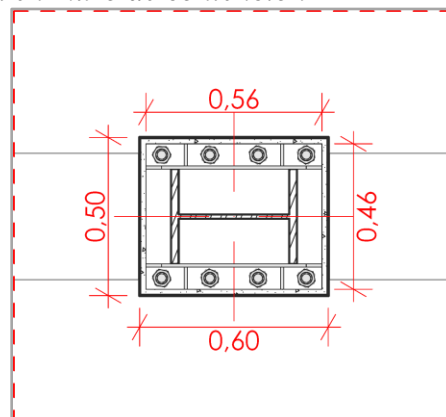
Sección de zapata con vista de pernos de anclaje
